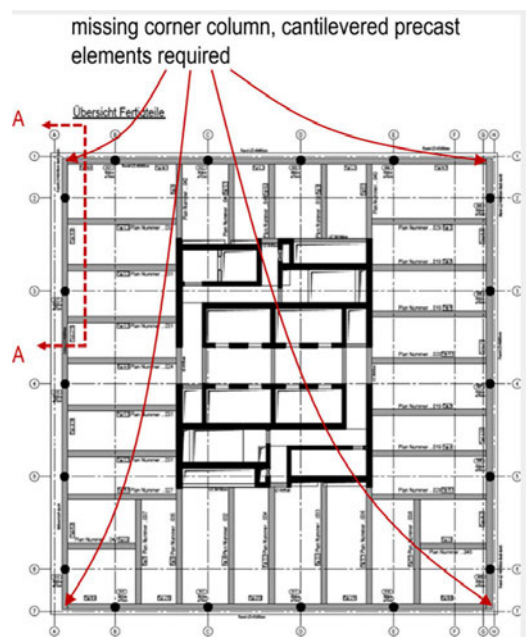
Grundriss Regelgeschoss mit fehlenden Eckstützen
